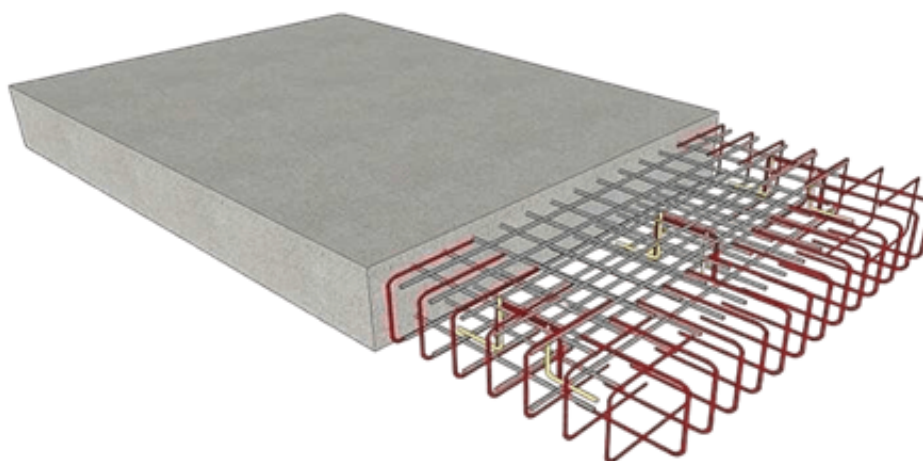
Плита перекриття/покриття монолітна залізобетонна
